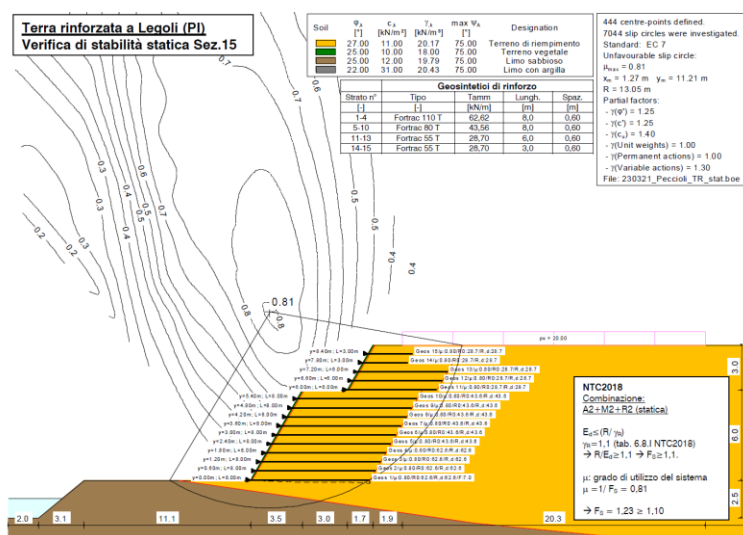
/3 – Verifica muro in TR doppia parete: stabilità statica
